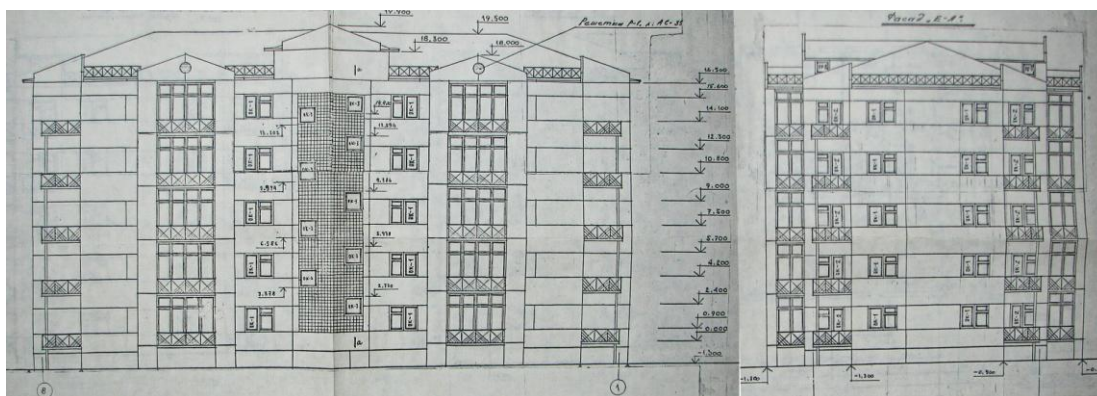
Чертежи фасадов жилого дома по ул. Ботаническая, д. 1Е
